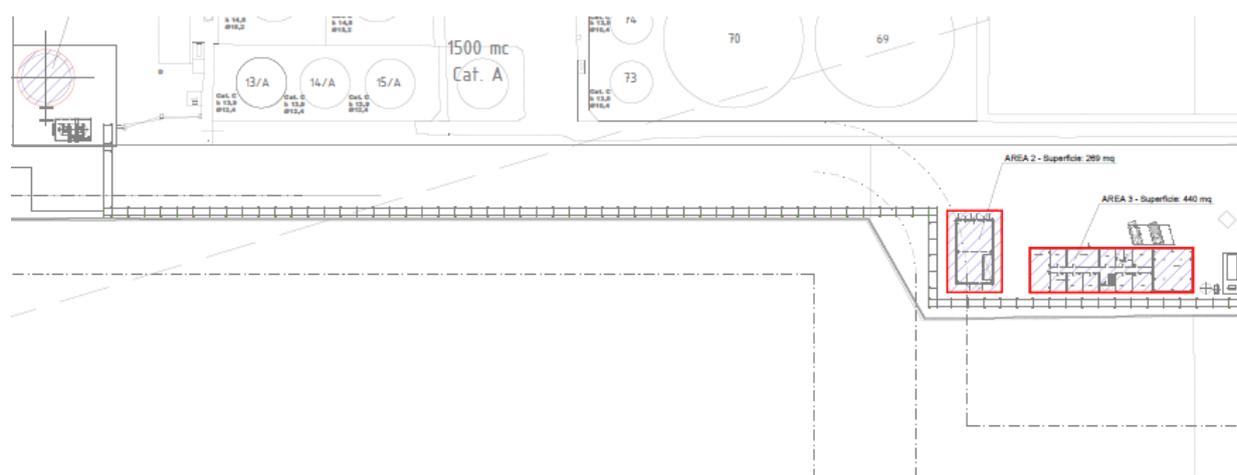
h: Planimetria delle Aree di Scavo a Sezione Obbligatoria per l'Area Sud dell'Impianto
